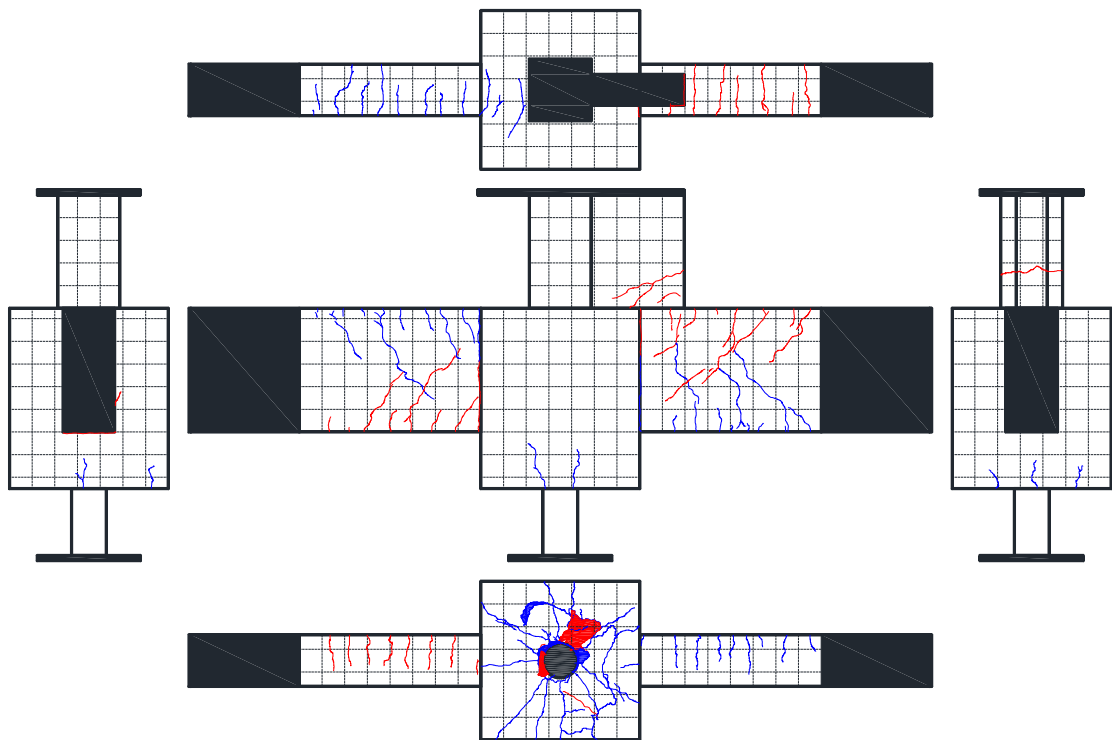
試験体 DR-5 ひび割れ状況 (7Cycle)
